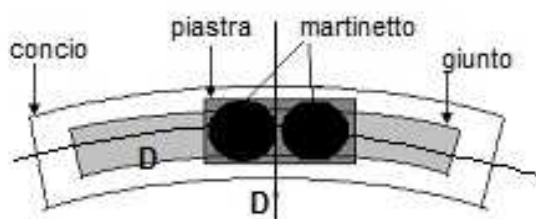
Applicazione della spinta sul giunto longitudinale – piani D e D' di armatura
